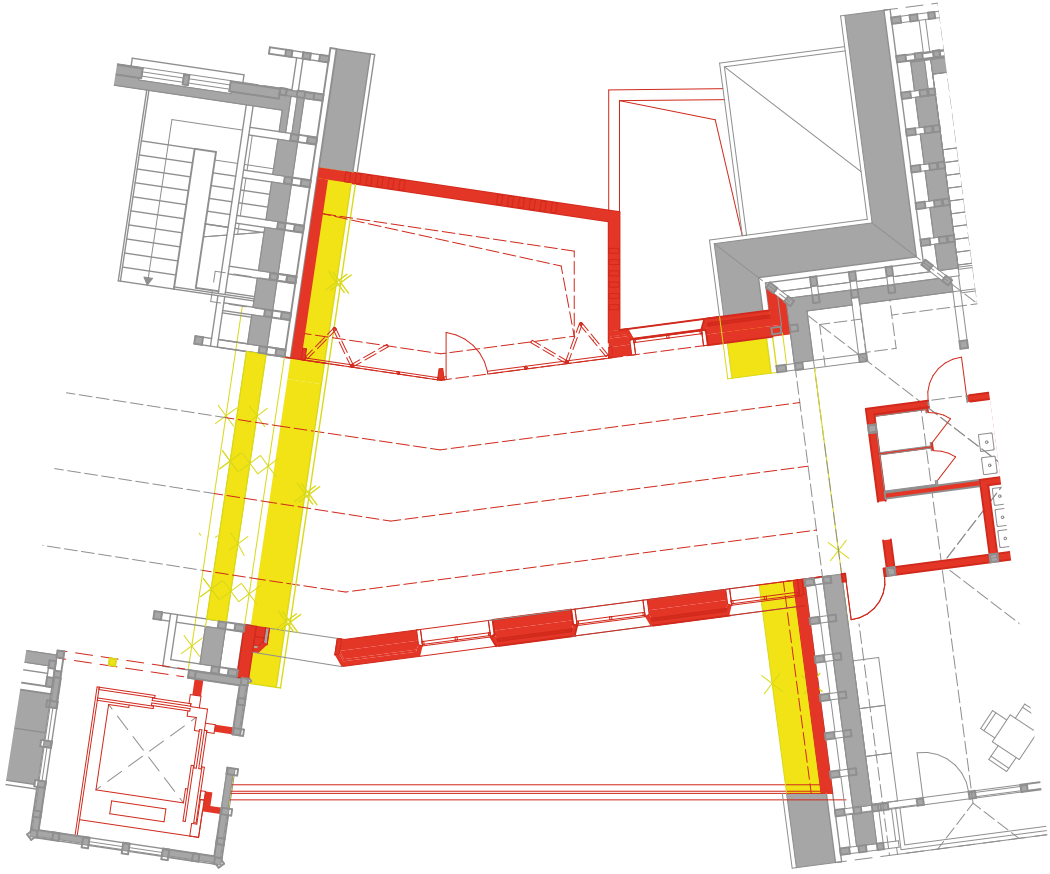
| Grundriss Abbruch/Neubau M3
